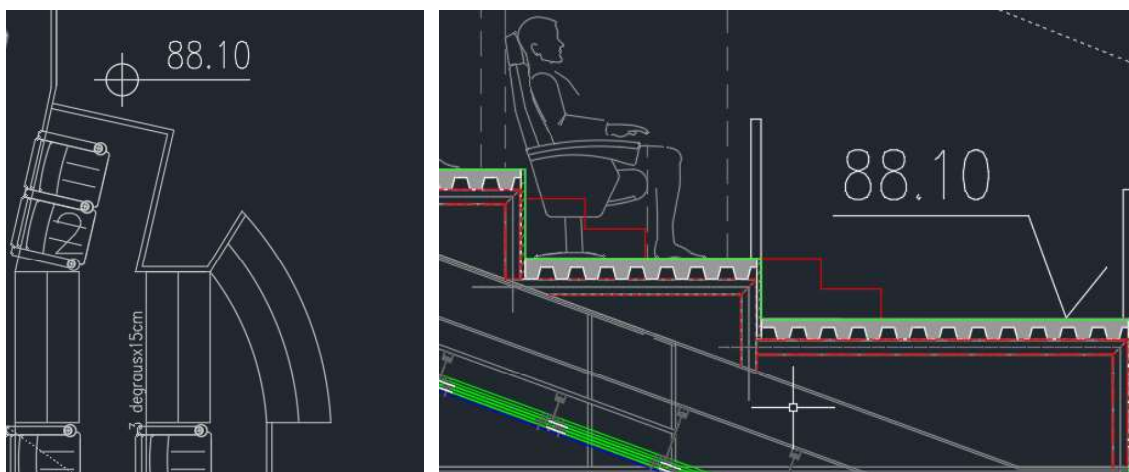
Detalhe em planta baixa e corte de incoerência na escada.
